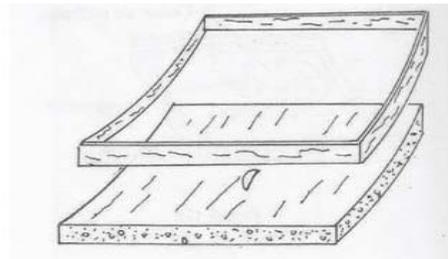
Fabricação das placas de parede com argamassa de cimento e areia de traço 1 : 4,5.
